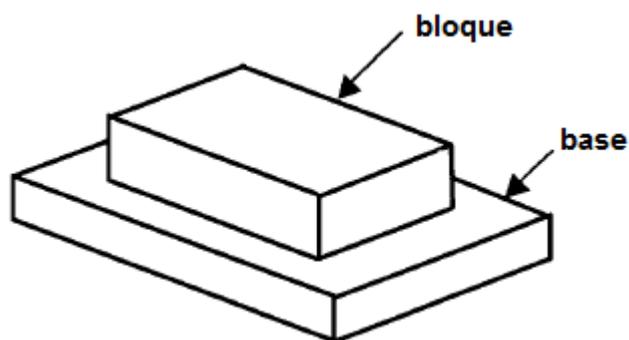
Cimentación tipo bloque. Fuente: ACI
